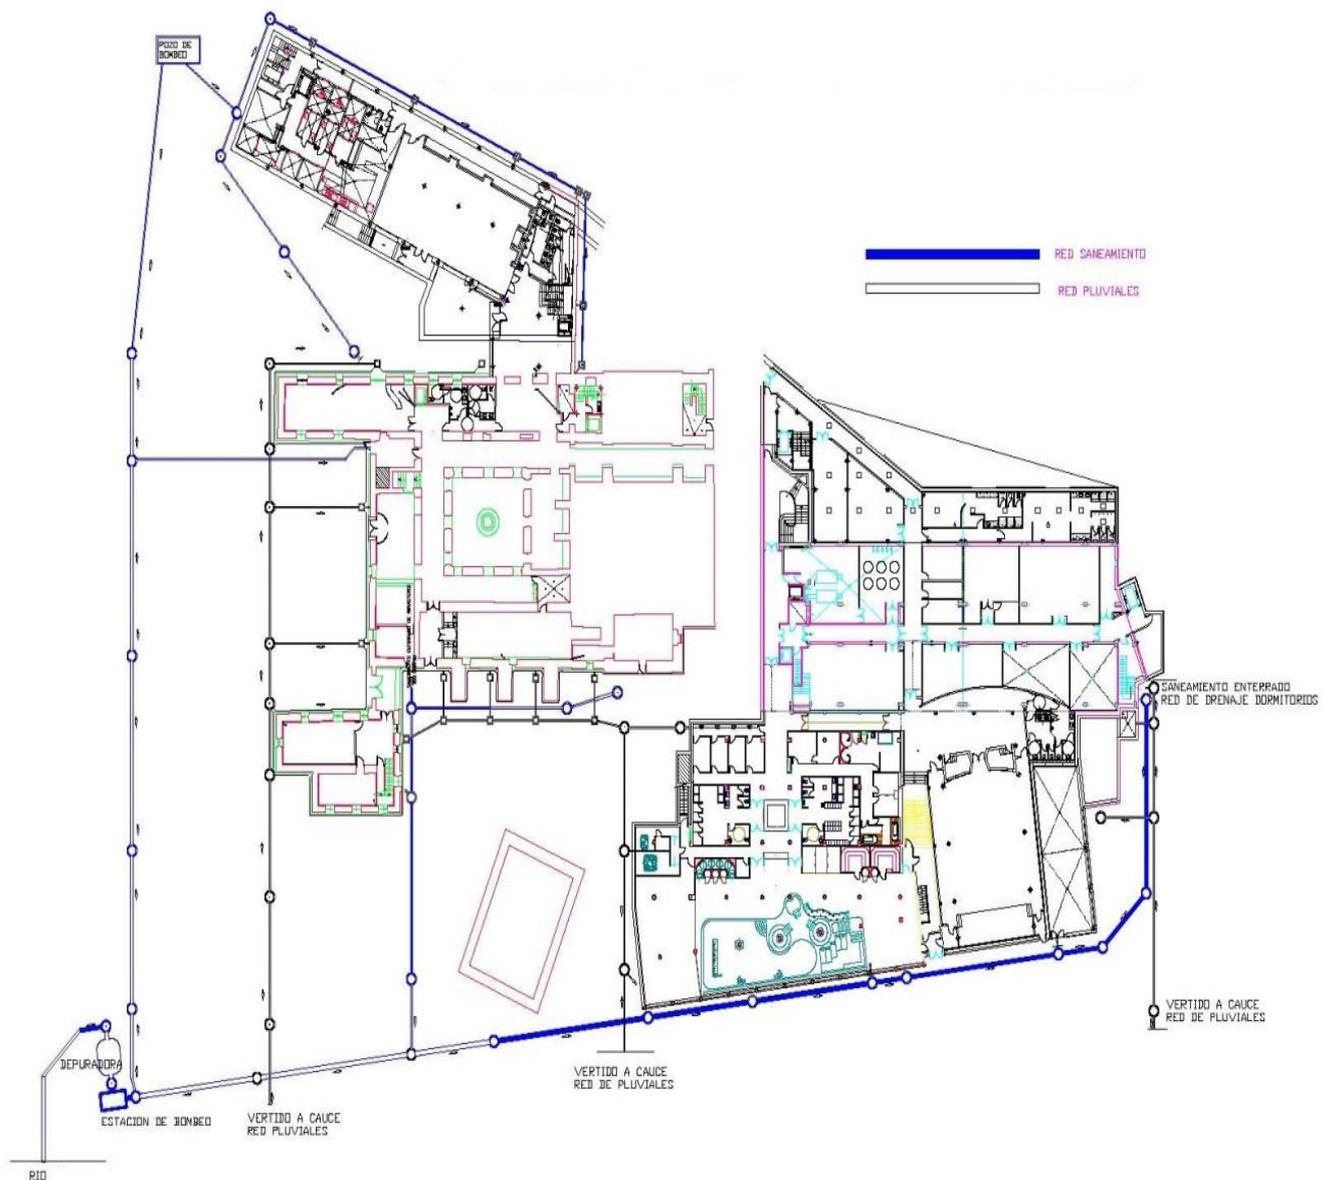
Plano complejo hotelero y redes de saneamiento y pluviales
